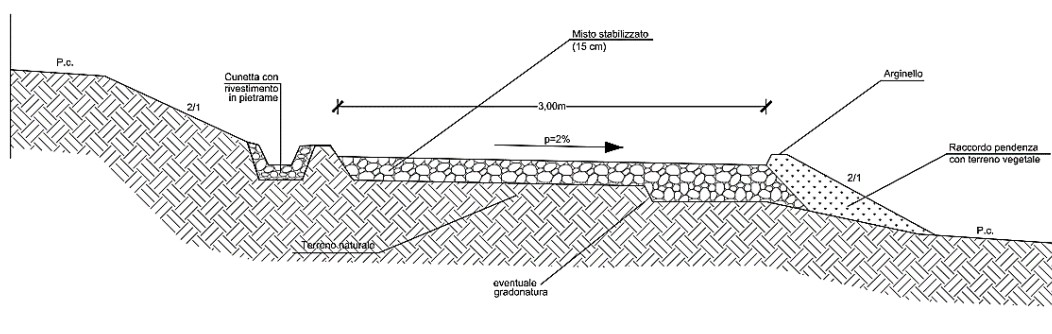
Sezione tipo strade interne al sito, tipologia a mezza costa (Fonte: ns elaborazione)
